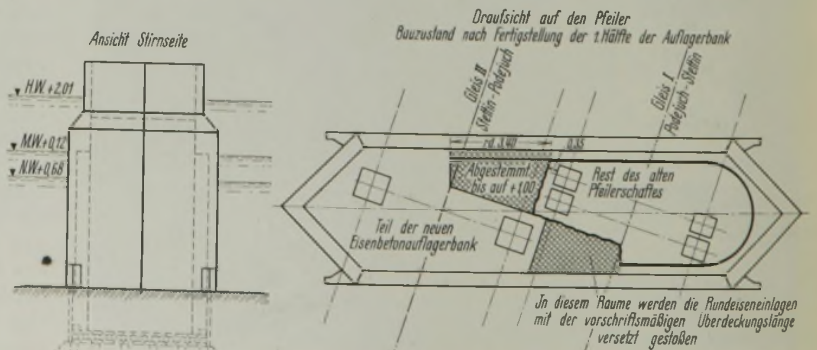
Durchgehende Eisenbetonaullagerbank im ersten Bauabschnitt fertiggestellt.
